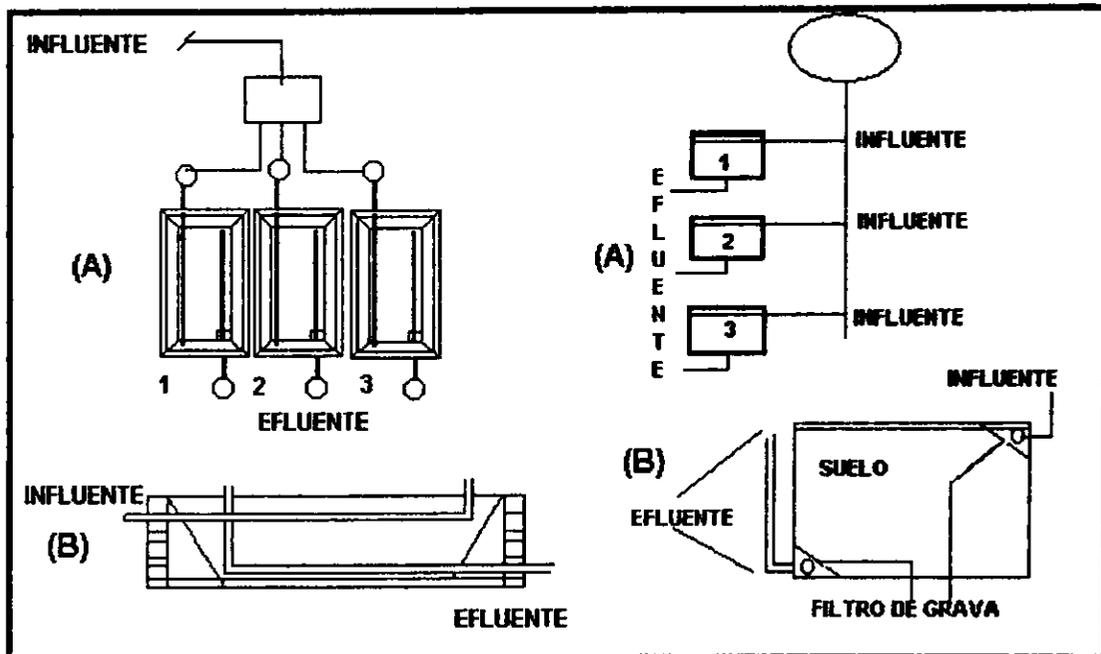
VISTA SUPERIOR Y CORTE LONGITUDINAL DEL MÓDULO PILOTO (a la izquierda) Y DEL MÓDULO DE LABORATORIO (a la derecha) CONSTRUIDOS POR LA UAM (Modificado de Kreiner et al., 1992).
